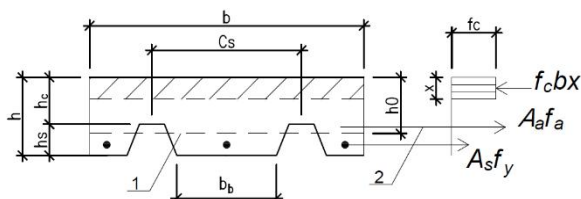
Эскиз расчета на изгиб комбинированных плит перекрытия:
